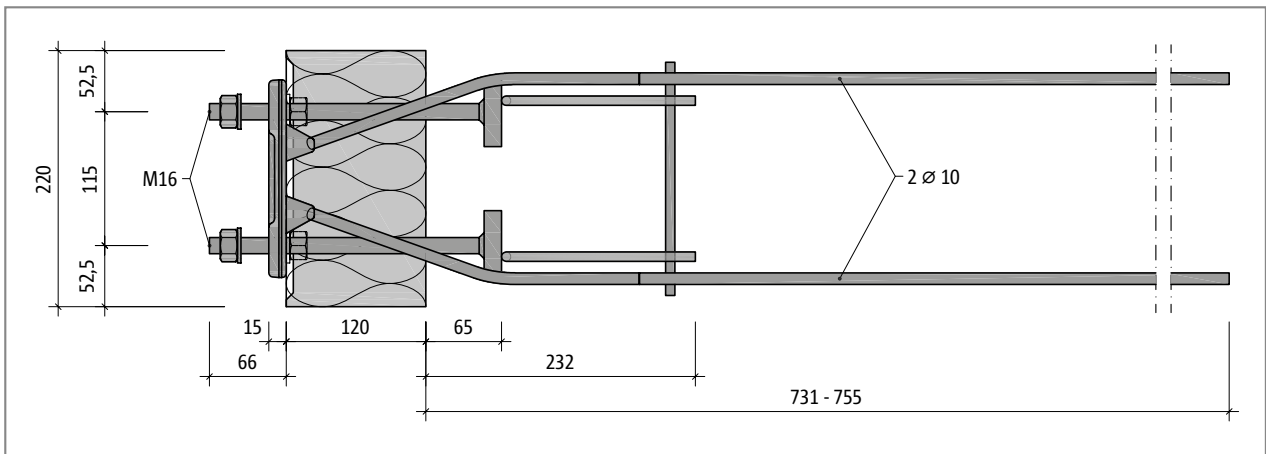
Schöck Isokorb® Typ QSXT10: Grundriss
